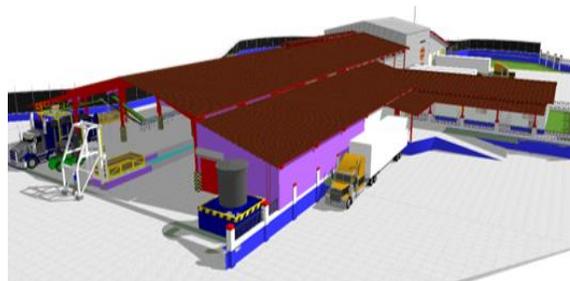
Vista en frontal de la Planta Empacadora de Santa Fe.
